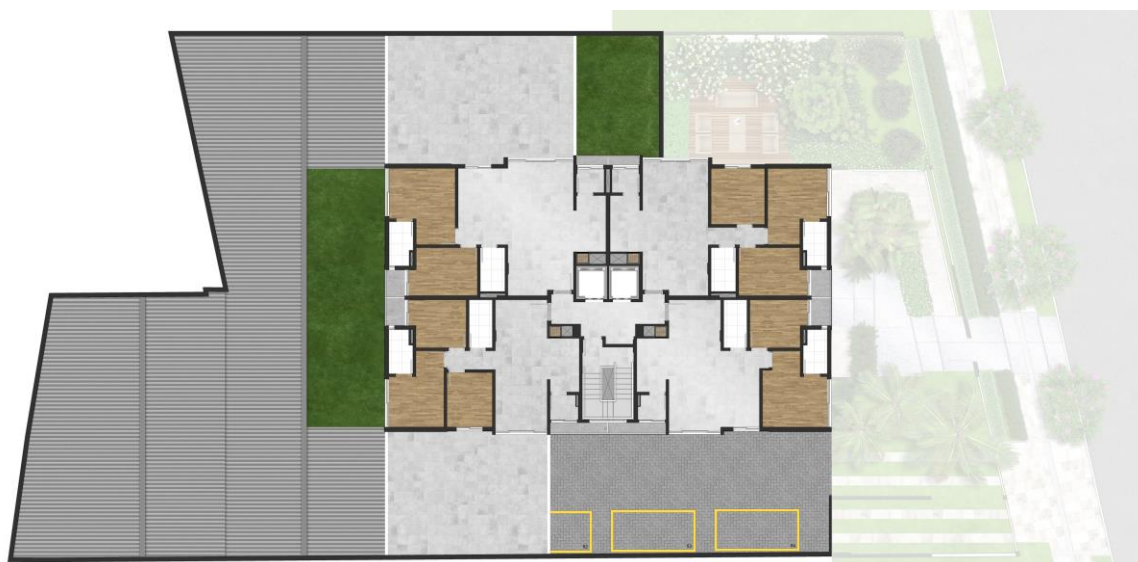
Planta Baixa do 2º Pavimento do Munich (Spectro Arquitetura - Ano 2016).
